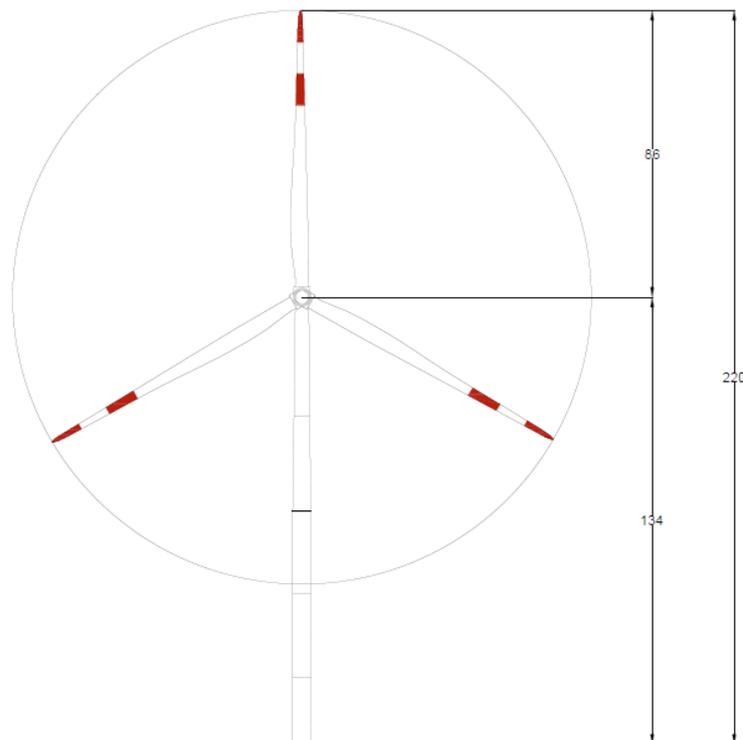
Segnalazione cromatica su prospetto frontale dell'aerogeneratore
